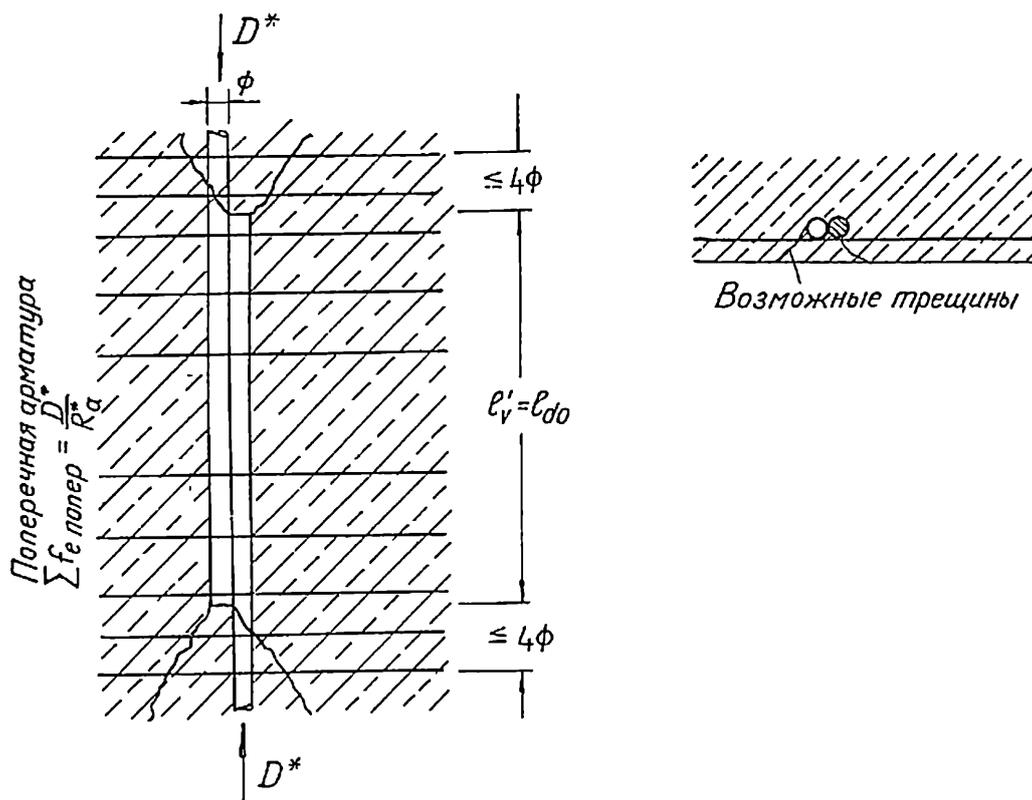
10. Стык внахлестку для сжатых стержней (поперечная арматура также необходима и за концами стержней)
